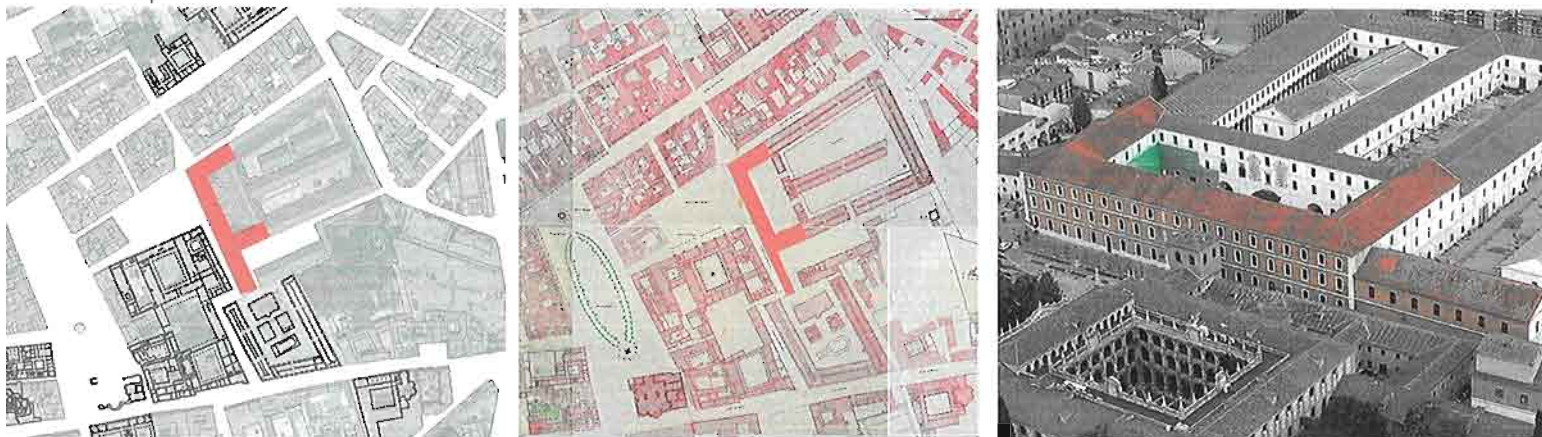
Plano de situación, plano histórico s.XIX y vista del cuartel antes de la intervención / Figure 2 Site plan, historic plan XIX century and barrack view before intervention
